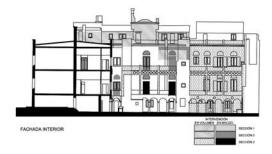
Alzado de la fachada del patio y sección del edificio de la calle Mall, con indicación de las diferentes intervenciones (Jordi Salvat)
